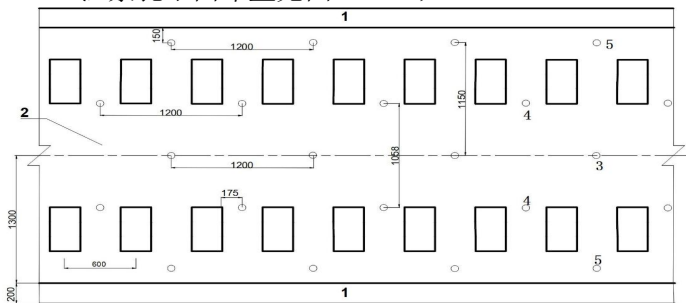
注浆孔布置平面示意图（单位：mm）
